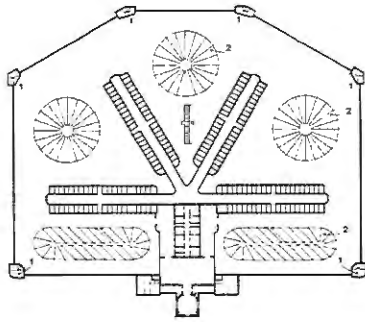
Planta da prisão Pentoville, Londres (1840-42).
